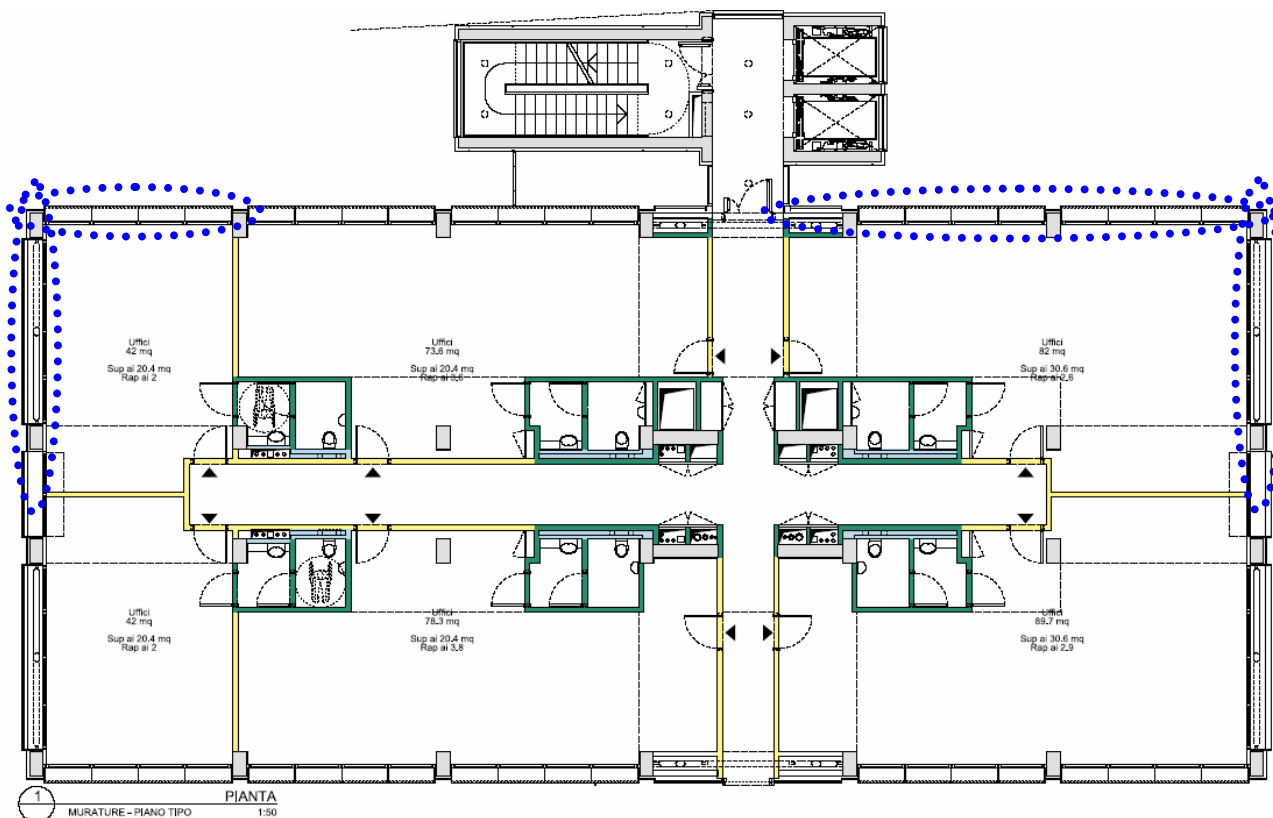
Indicazione delle facciate oggetto di valutazione, piano tipo
